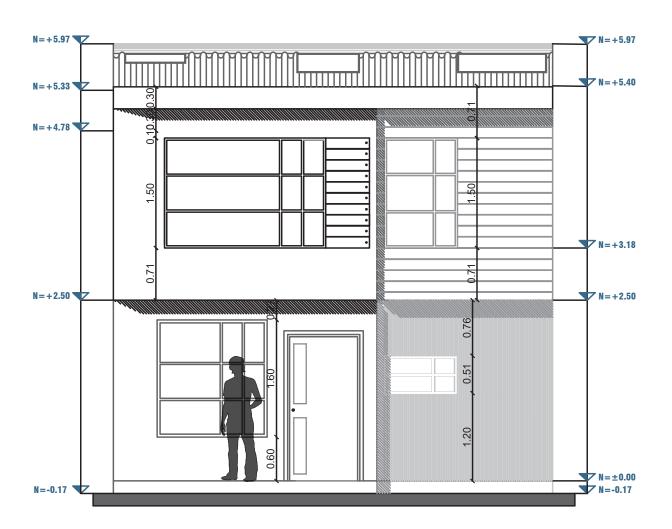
Fachada frontal propuesta Nota: Elaborado por el autor
